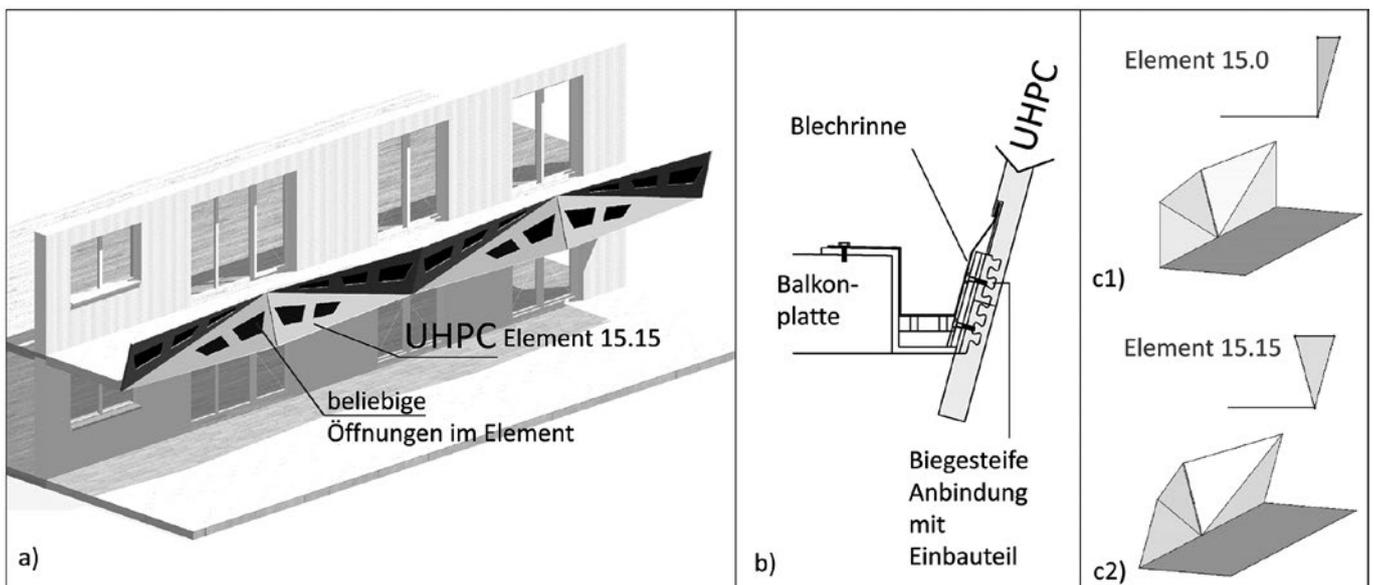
a) UHPC Balkonelemente 15.15 mit Öffnungen b) biegesteifer Anschlussstyp, c) Elementformen
